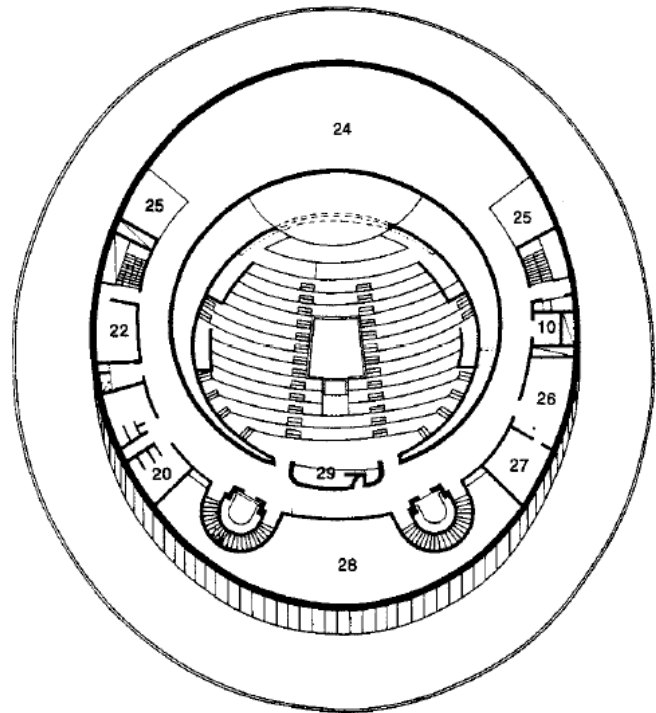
Primer Nivel centro cultural alfa planta arquitectónica.
